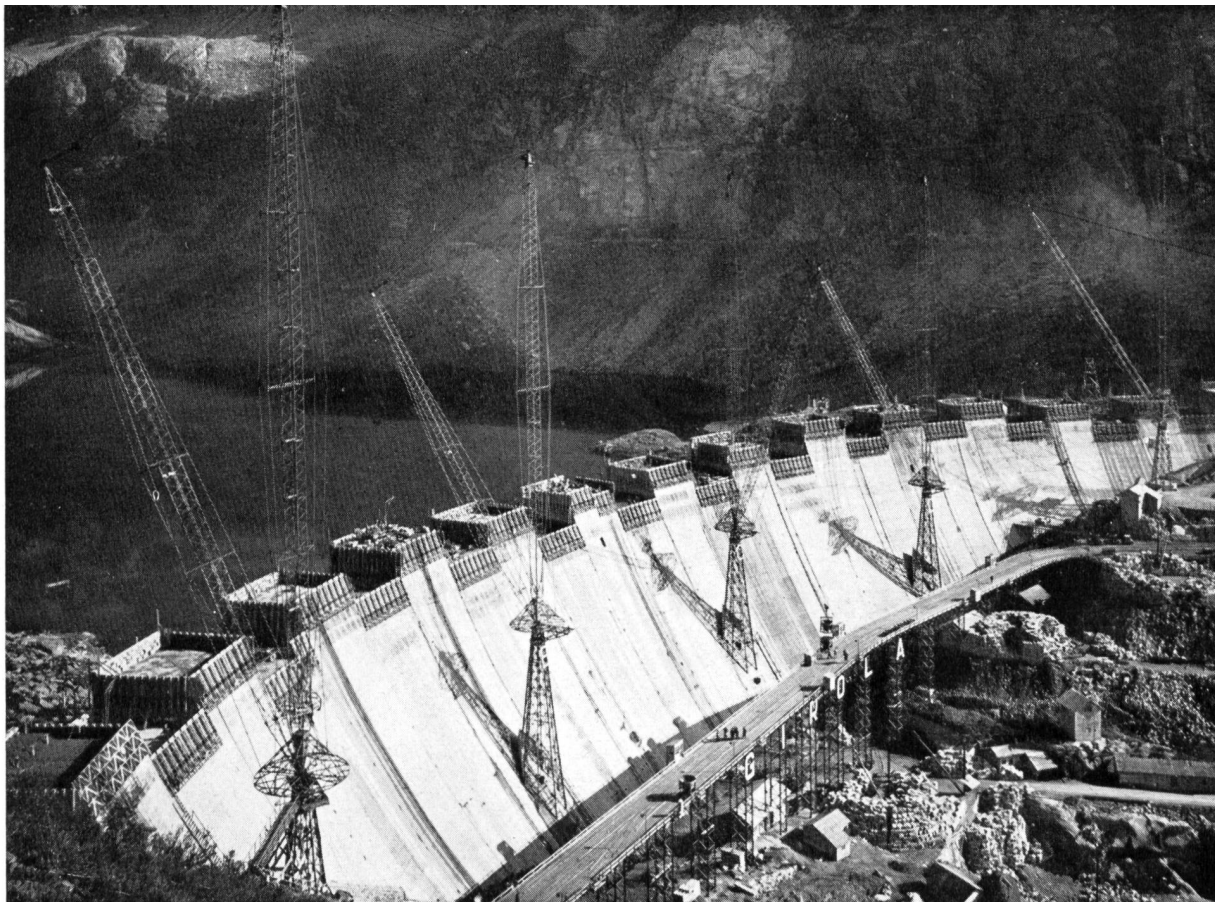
Staumauer Pian Telesio, Italien: Betonplazierung mit Derrikkranen
